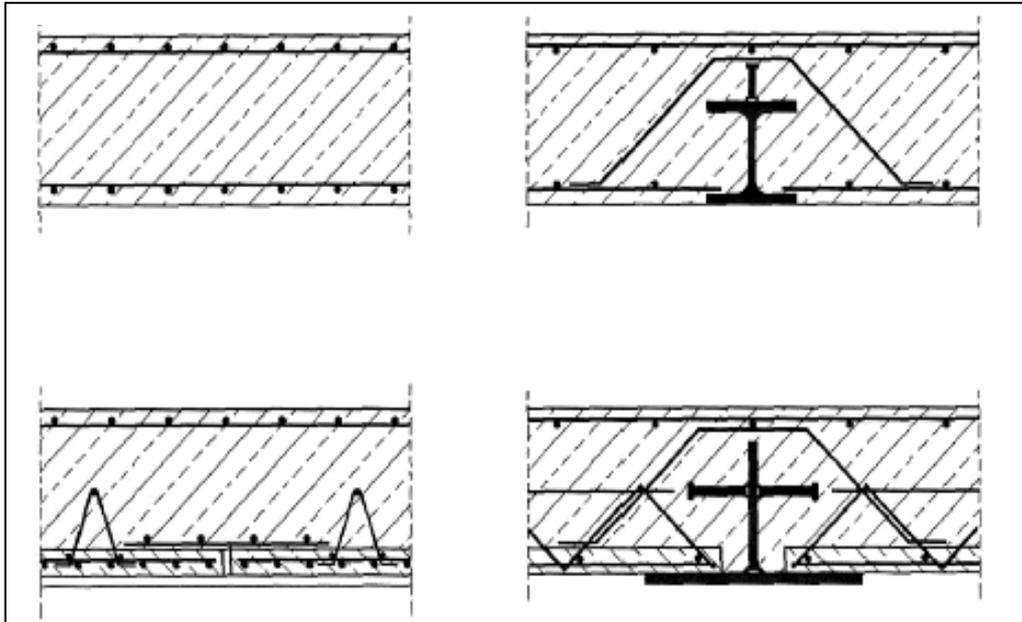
Stahlbetondecken als Flachdecken, Ausführungsformen, aus [9]
